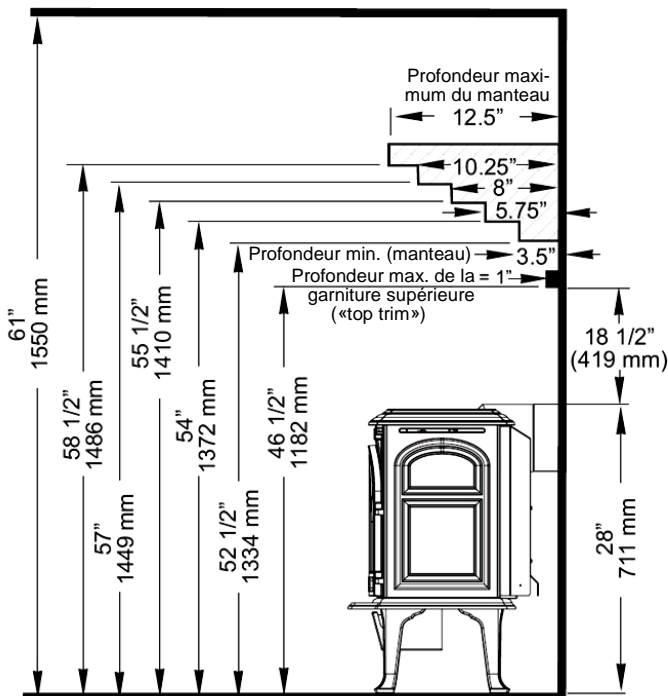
Dégagements du manteau avec pattes standard. Réduisez de 2-1/4 po la hauteur du poêle et les valeurs de dégagements, si vous installez le kit optionnel de pattes courtes.
